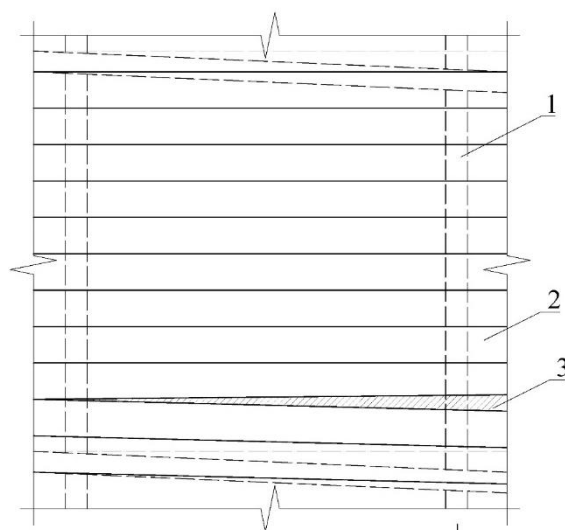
Принципиальная схема дефекта - осадка элементов каркасных стен деревянного здания с образованием перекосов и щелей: 1 – стойка каркаса; 2 – элемент обшивки стены (доска); 3 – щель между элементами обшивки стены.
